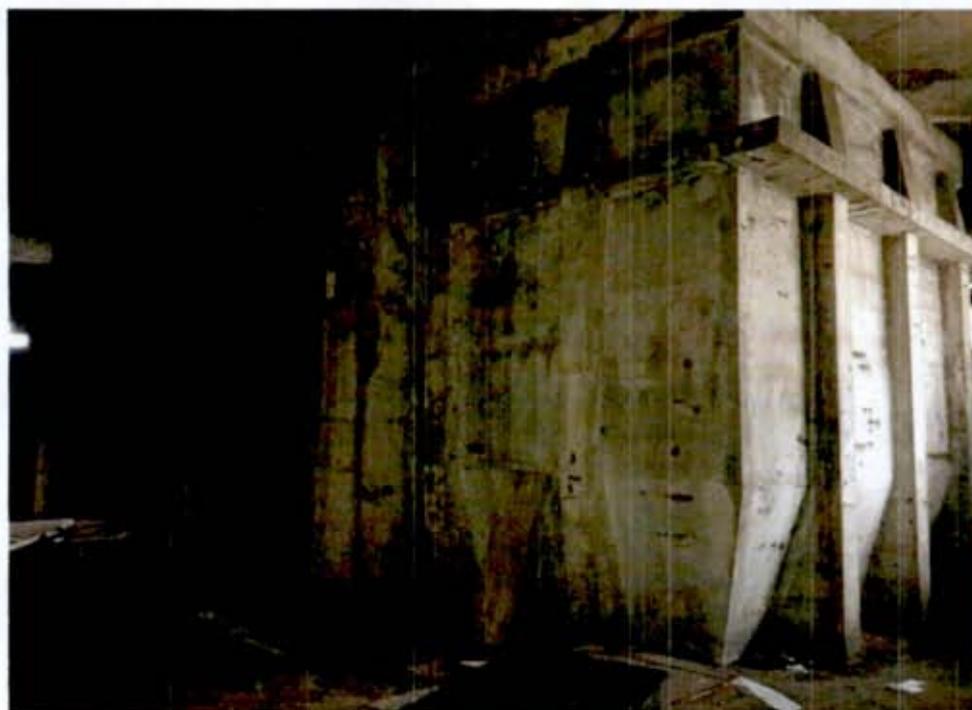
Железобетонный бак в бывш. отделение водоподготовки.
